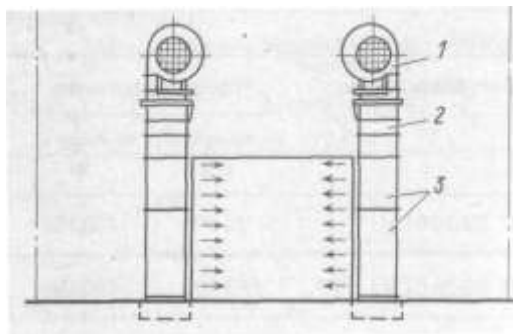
Конструкция несущего стояка воздушной завесы заводского изготовления
